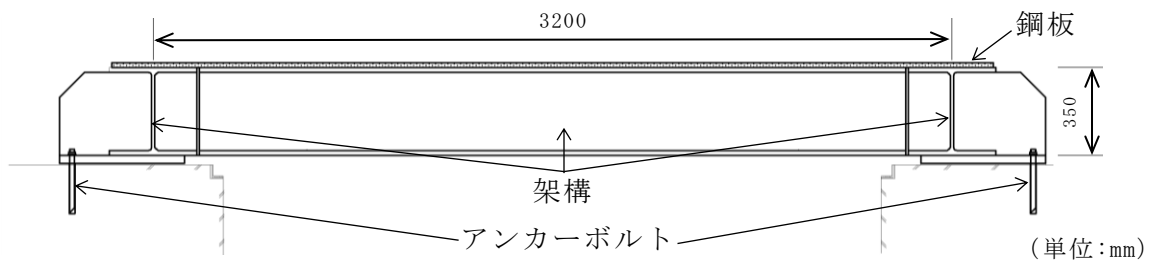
取水槽循環水ポンプエリア防護対策設備の概略断面図 (A-A 断面)
